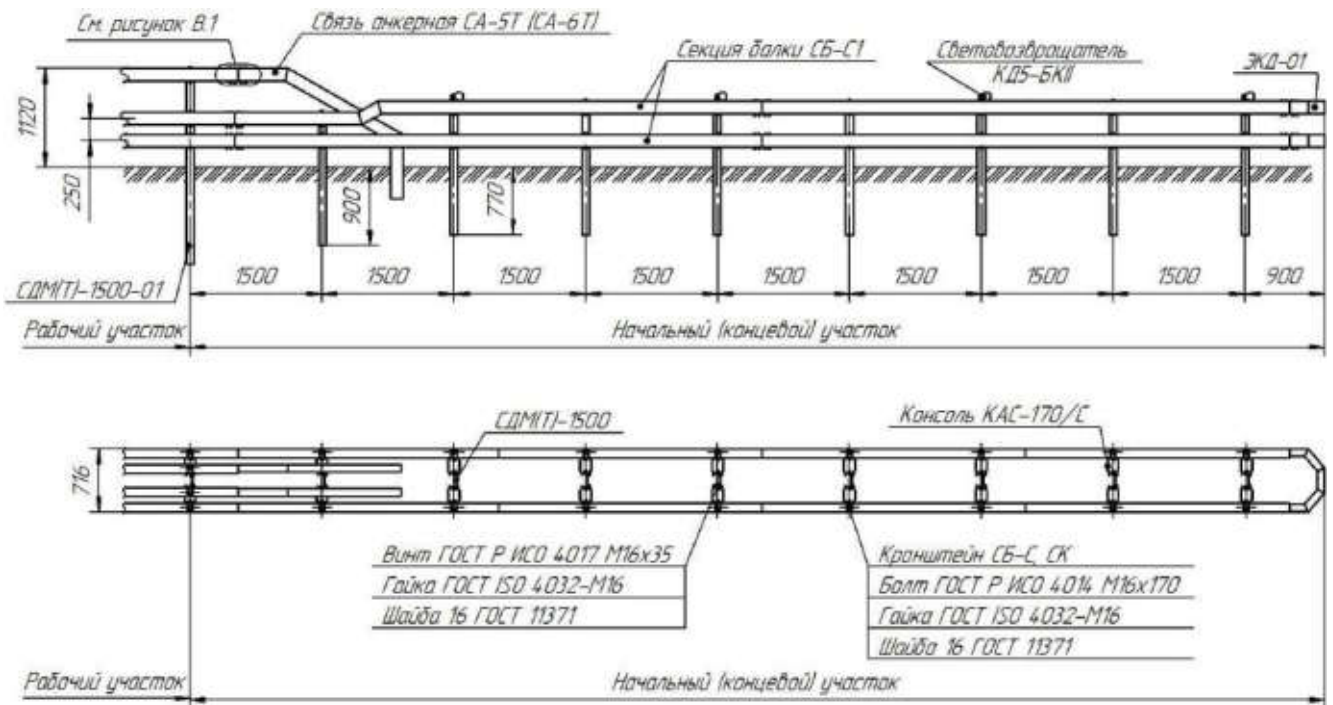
Схема сборки конструкции №14 (Изм. №1)
